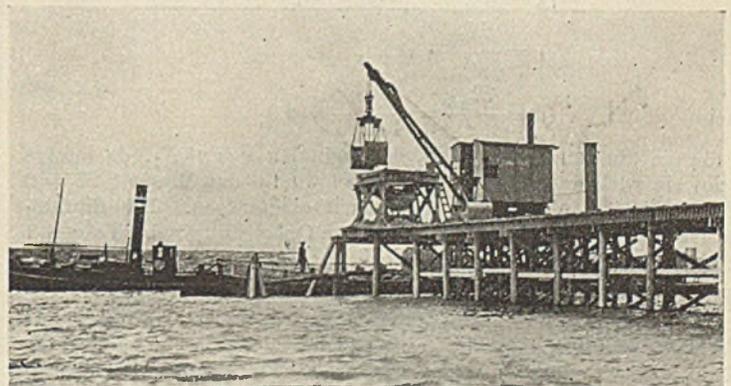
Ladebrücke des Geschiebemergels für den Ausbau des Dammes auf dem Watt.
